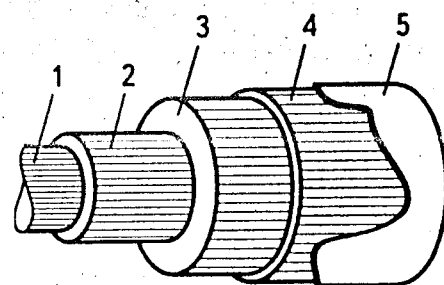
Мастичная конструкция тепловой изоляции:
